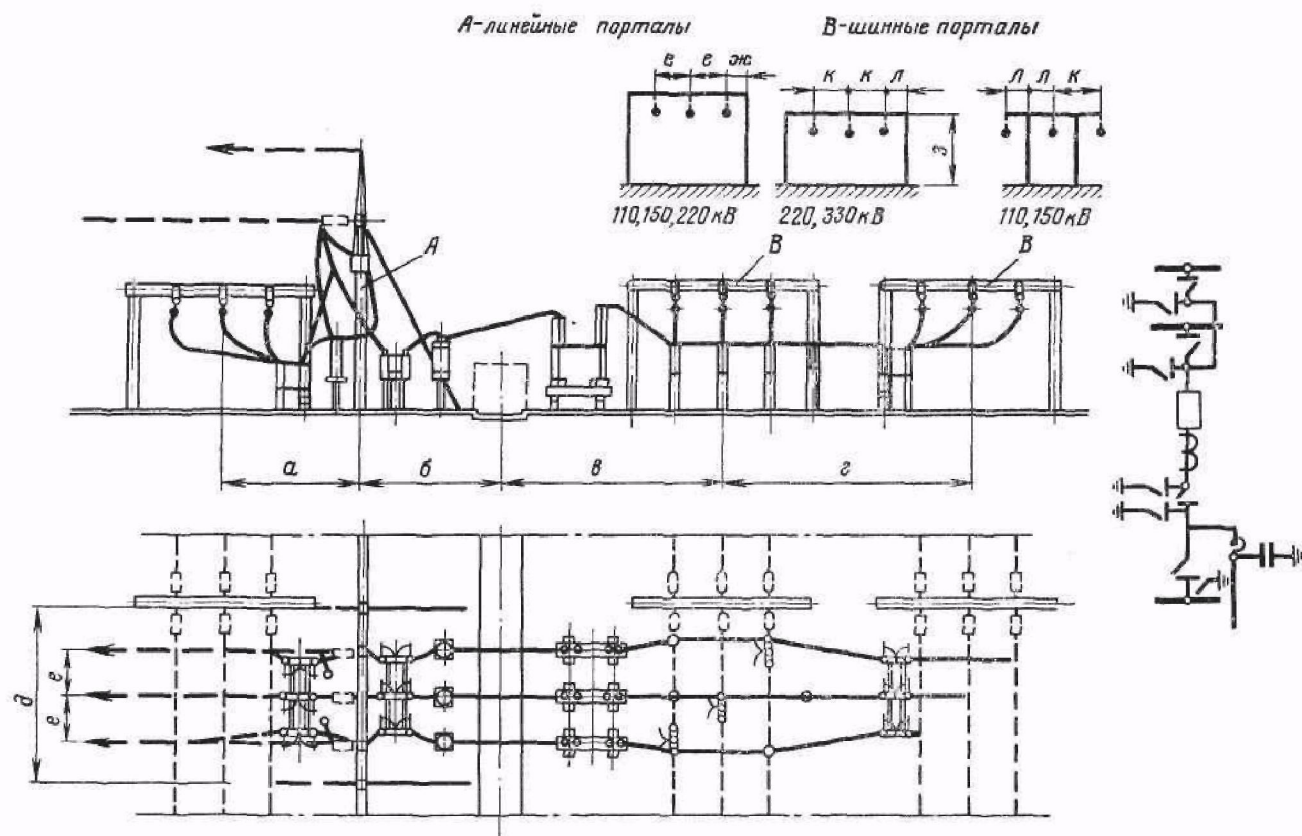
Компоновка ОРУ 110–220 кВ для схемы с двумя рабочими и обходной системами шин
